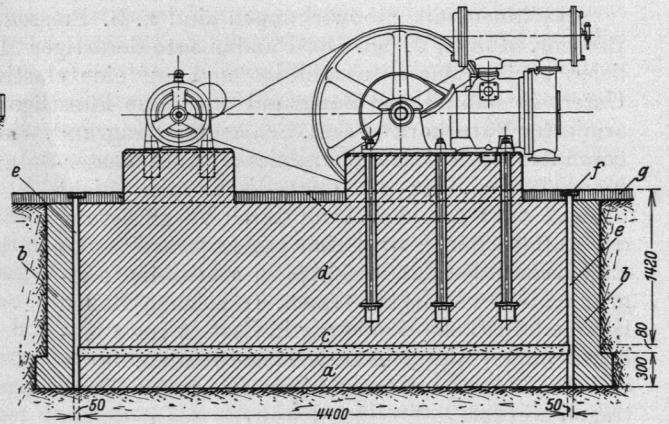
Fundament eines Kolbenkompressors mit Riemenantrieb.
